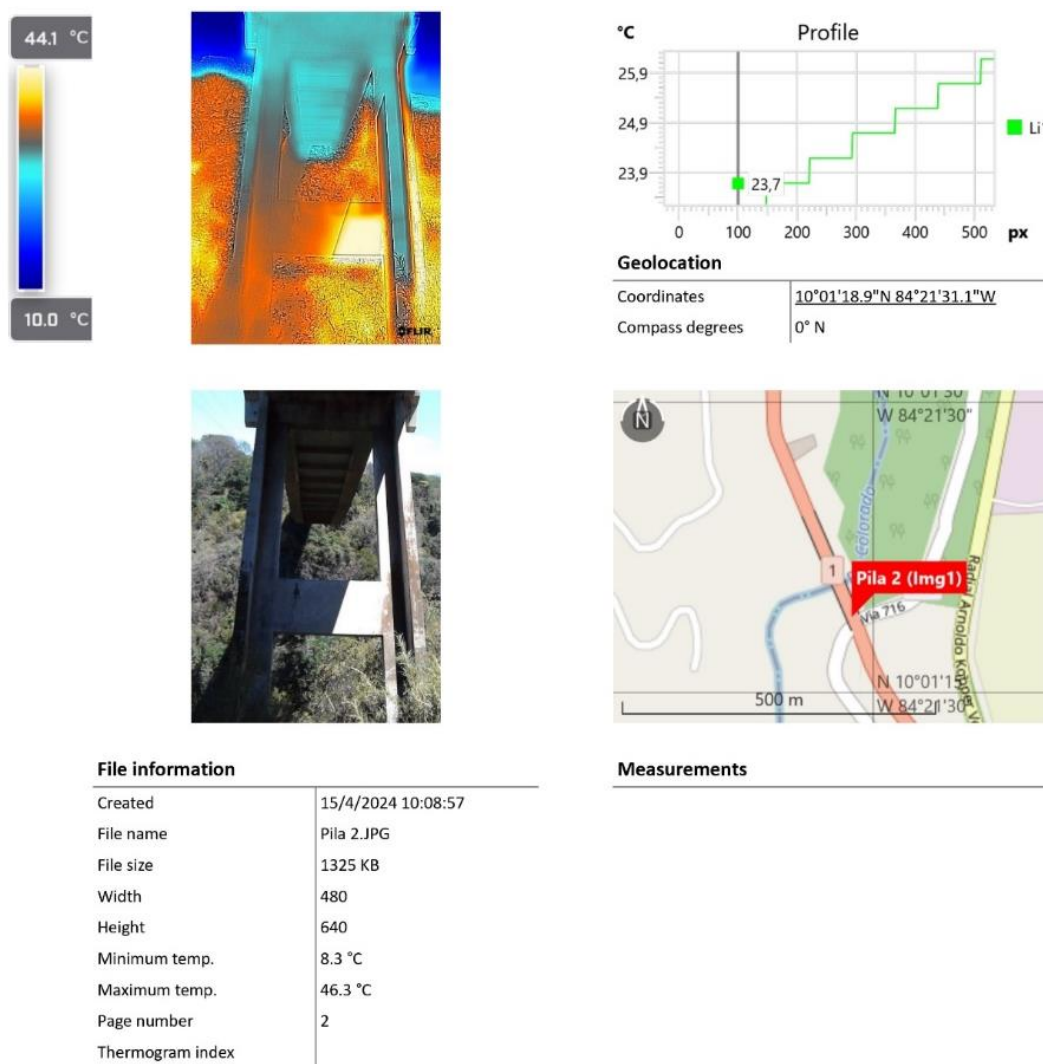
25 Reporte de grietas en cuerpo de la pila inclinada de la sección No. 3
